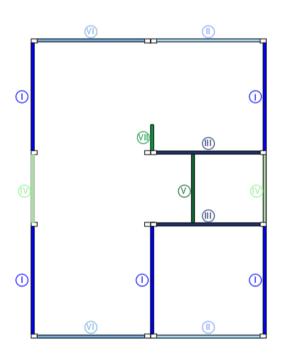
Vista en planta de las secciones tipo para mampostería vertical.
